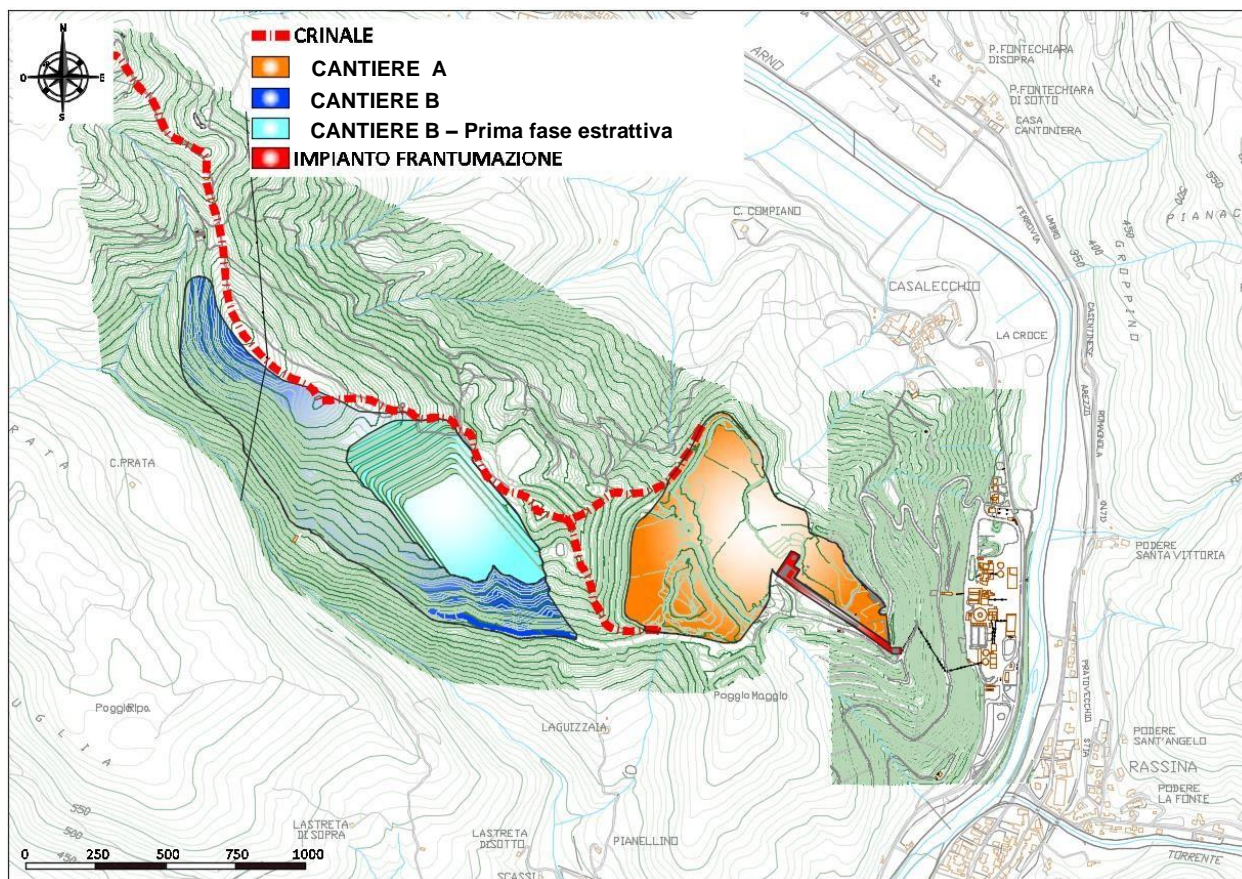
Individuazione delle distanze e del crinale che rendono confinato il cantiere
